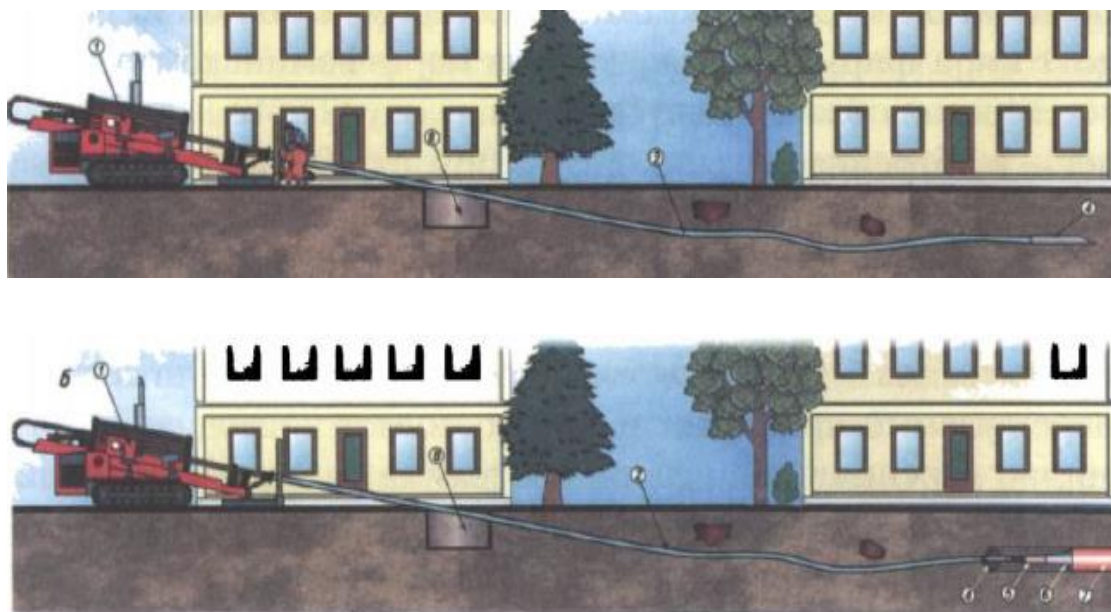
Технологічна схема прокладання комунікацій із застосуванням установки горизонтального спрямованого буріння: а – буріння пілотної свердловини; б – розширення свердловин та зворотне протягування; 1 – УГСБ; 2 – бурові штанги; 3 – бурова головка; 4 – розширювач; 5 – вертлюг; 6 – буксирна головка; 7 – прокладуваний трубопровід; 8 – стартовий котлован
